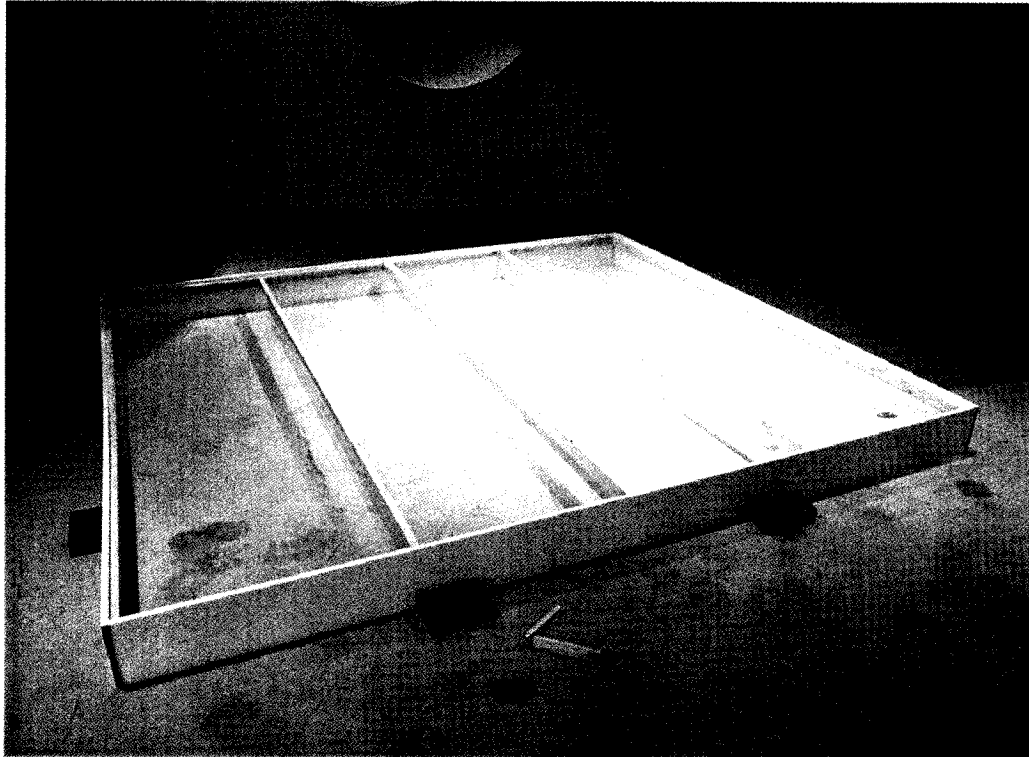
Ansicht Umfassungsrahmen mit Unterkonstruktion
